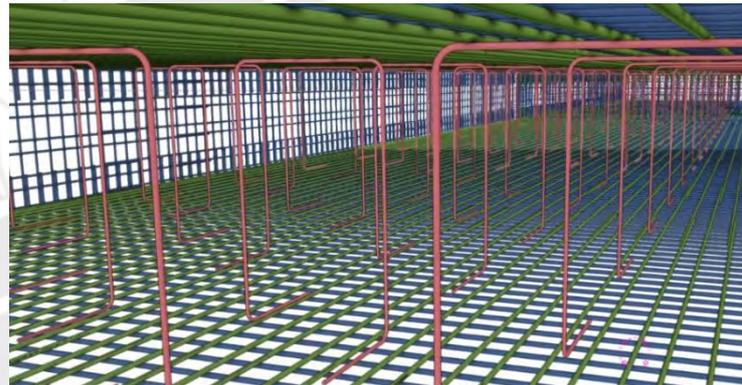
Separadores - detalles constructivos de acero de refuerzo
